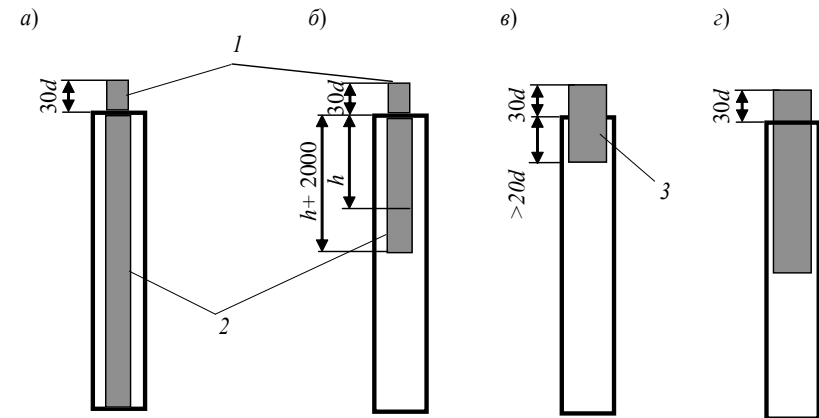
Схемы армирования буронабивных свай: а – армирование буронабивной сваи на всю глубину; б, в, г – неполное армирование свай; 1 – выпуски арматуры; 2 – арматурные каркасы; 3 – отдельные арматурные стержни; d – диаметр продольной арматуры
